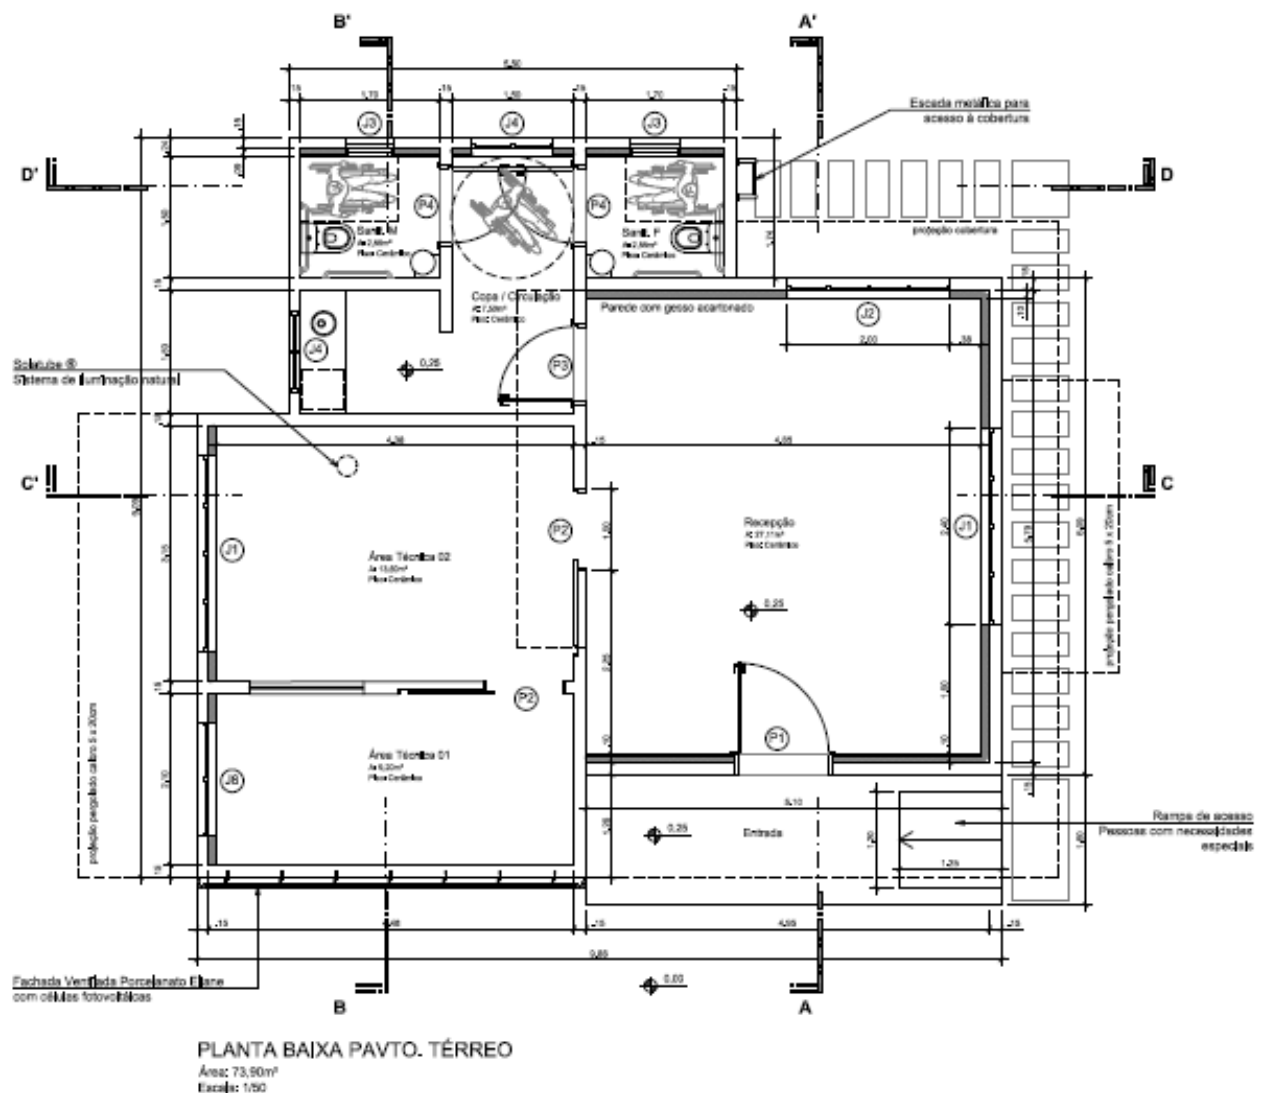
Planta baixa térreo (Fonte: Arquivo pessoal).
